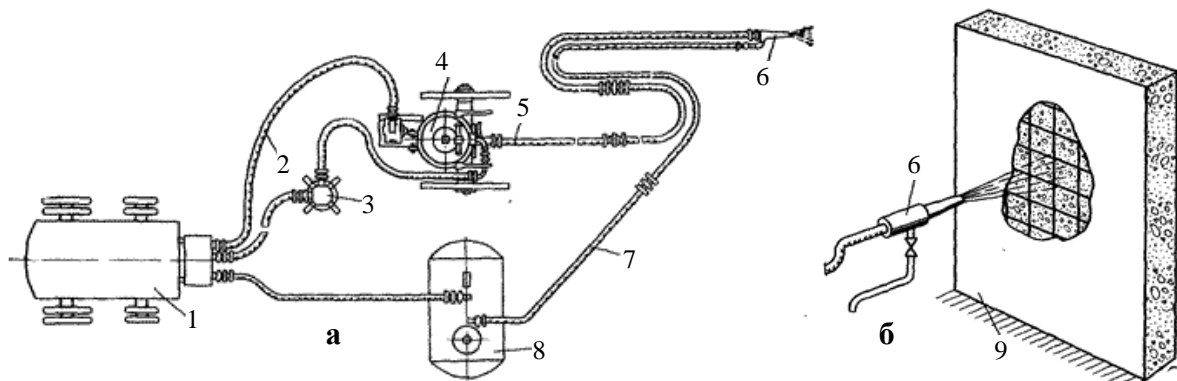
Схема торкретування бетону: а – схема установки; б – виправлення дефекту конструкції методом торкретування; 1 – пересувний компресор; 2 – рукава для подачі повітря; 3 – очищувач повітря; 4 – машина для набризку; 5 – рукав для подавання матеріалів; 6 – насадка; 7 – рукав для води; 8 – бак для води; 9 – дефектна конструкція
